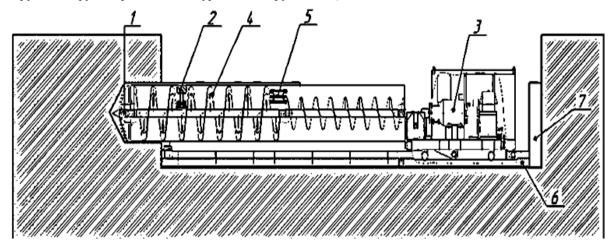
Установка для шнекового бурения скважин в грунте 1 – рабочий орган; 2 – передняя подвеска; 3 – установка для бурения скважины; 4 – шнековый транспортер; 5 – задняя подвеска; 6 – упорная рама; 7 – упорная стенка
